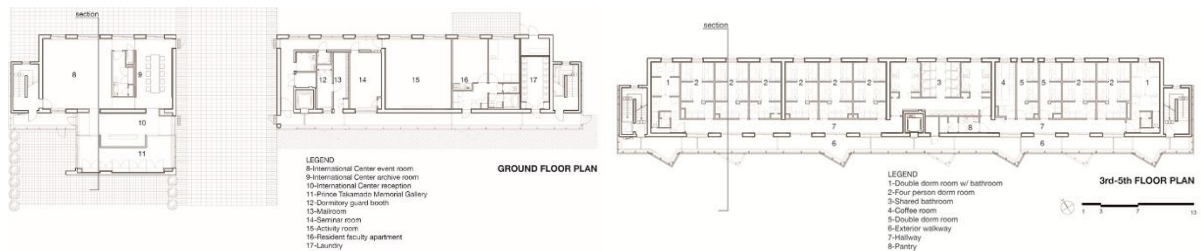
iHouse Dormitory. План 1-го та типового поверхів [25]
